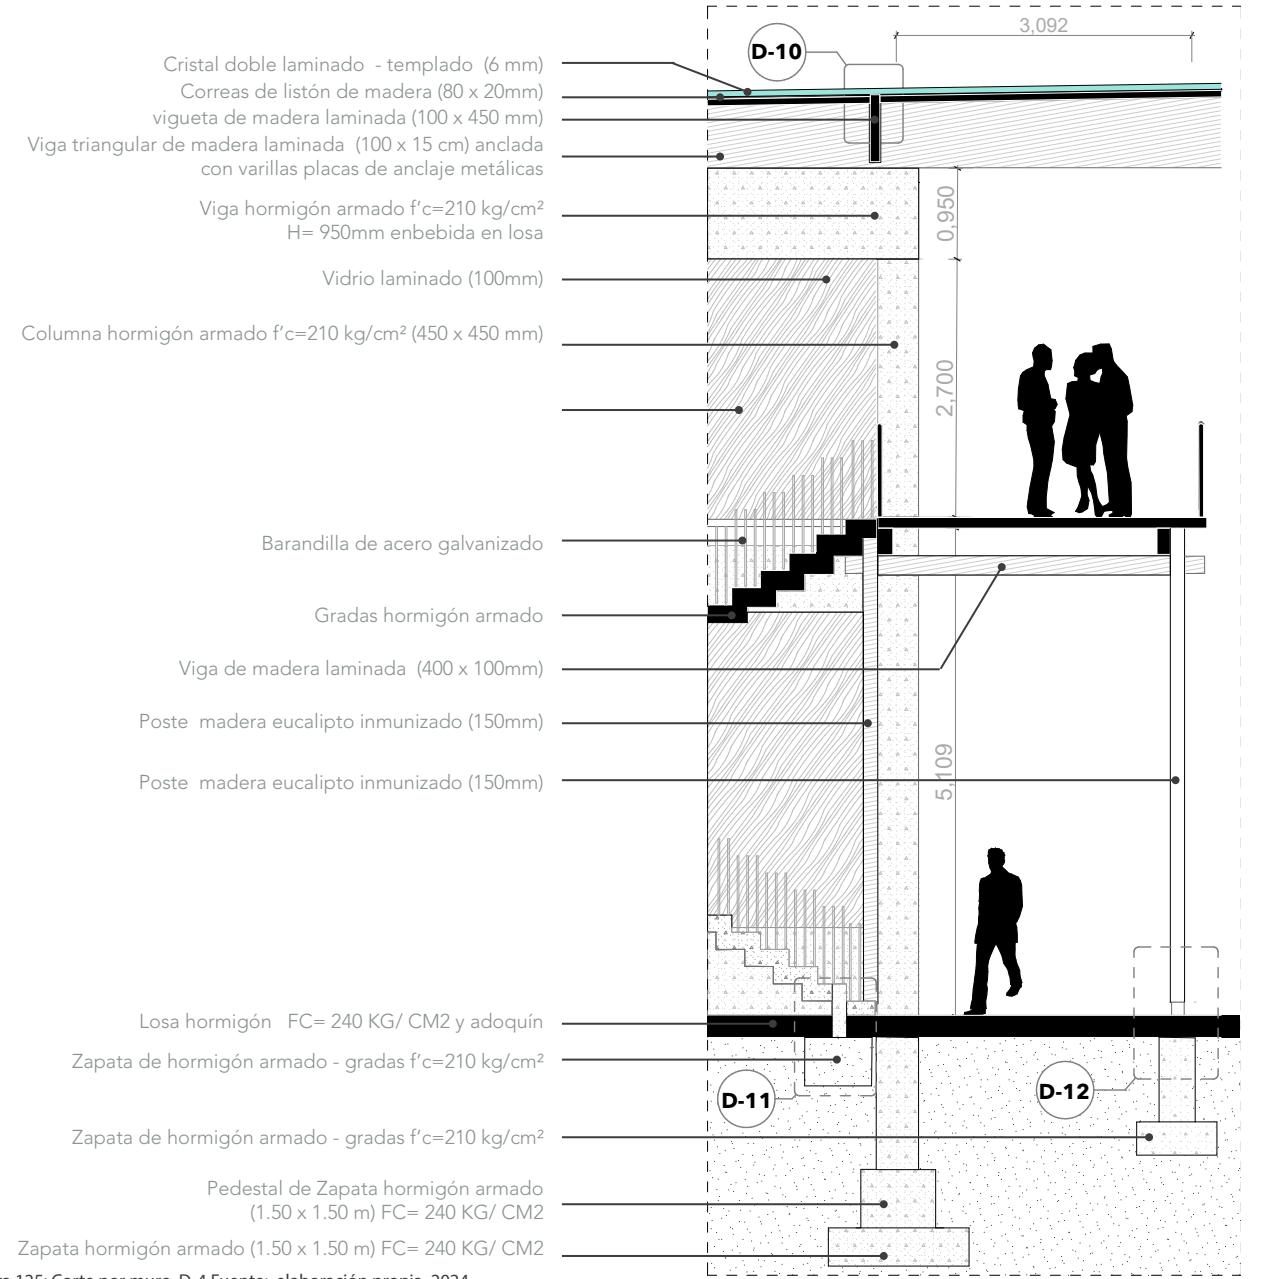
Corte por muro, D-4 Fuente: elaboración propia, 2024.
